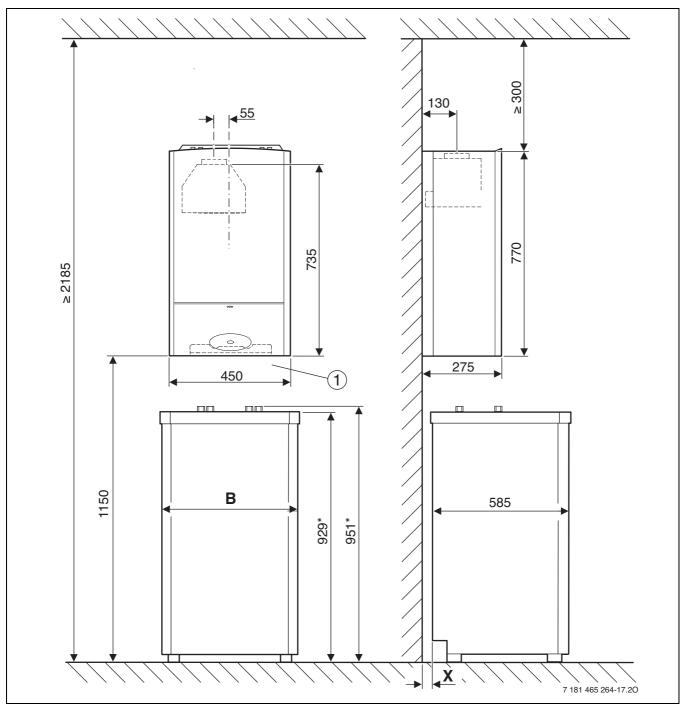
Einbaumaße ST 120-2 E und ST 160-2 E mit Ceramini ZSN 11-7 KE
